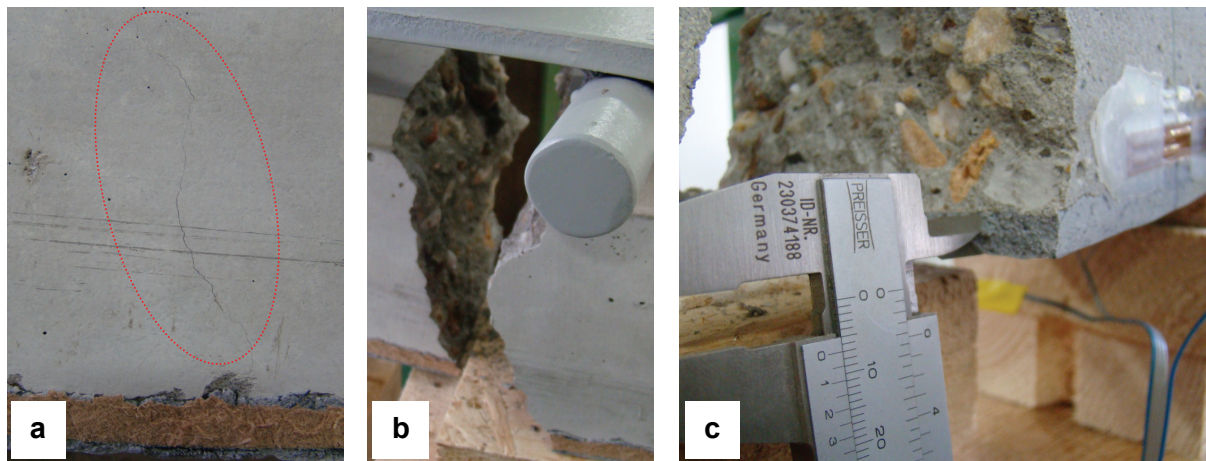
Versagensbilder der KfV-beschichteten Betonträger; a: Entstehung von Rissen; b: Bruch; c: Ansicht des Querschnitts im Versagensbereich
